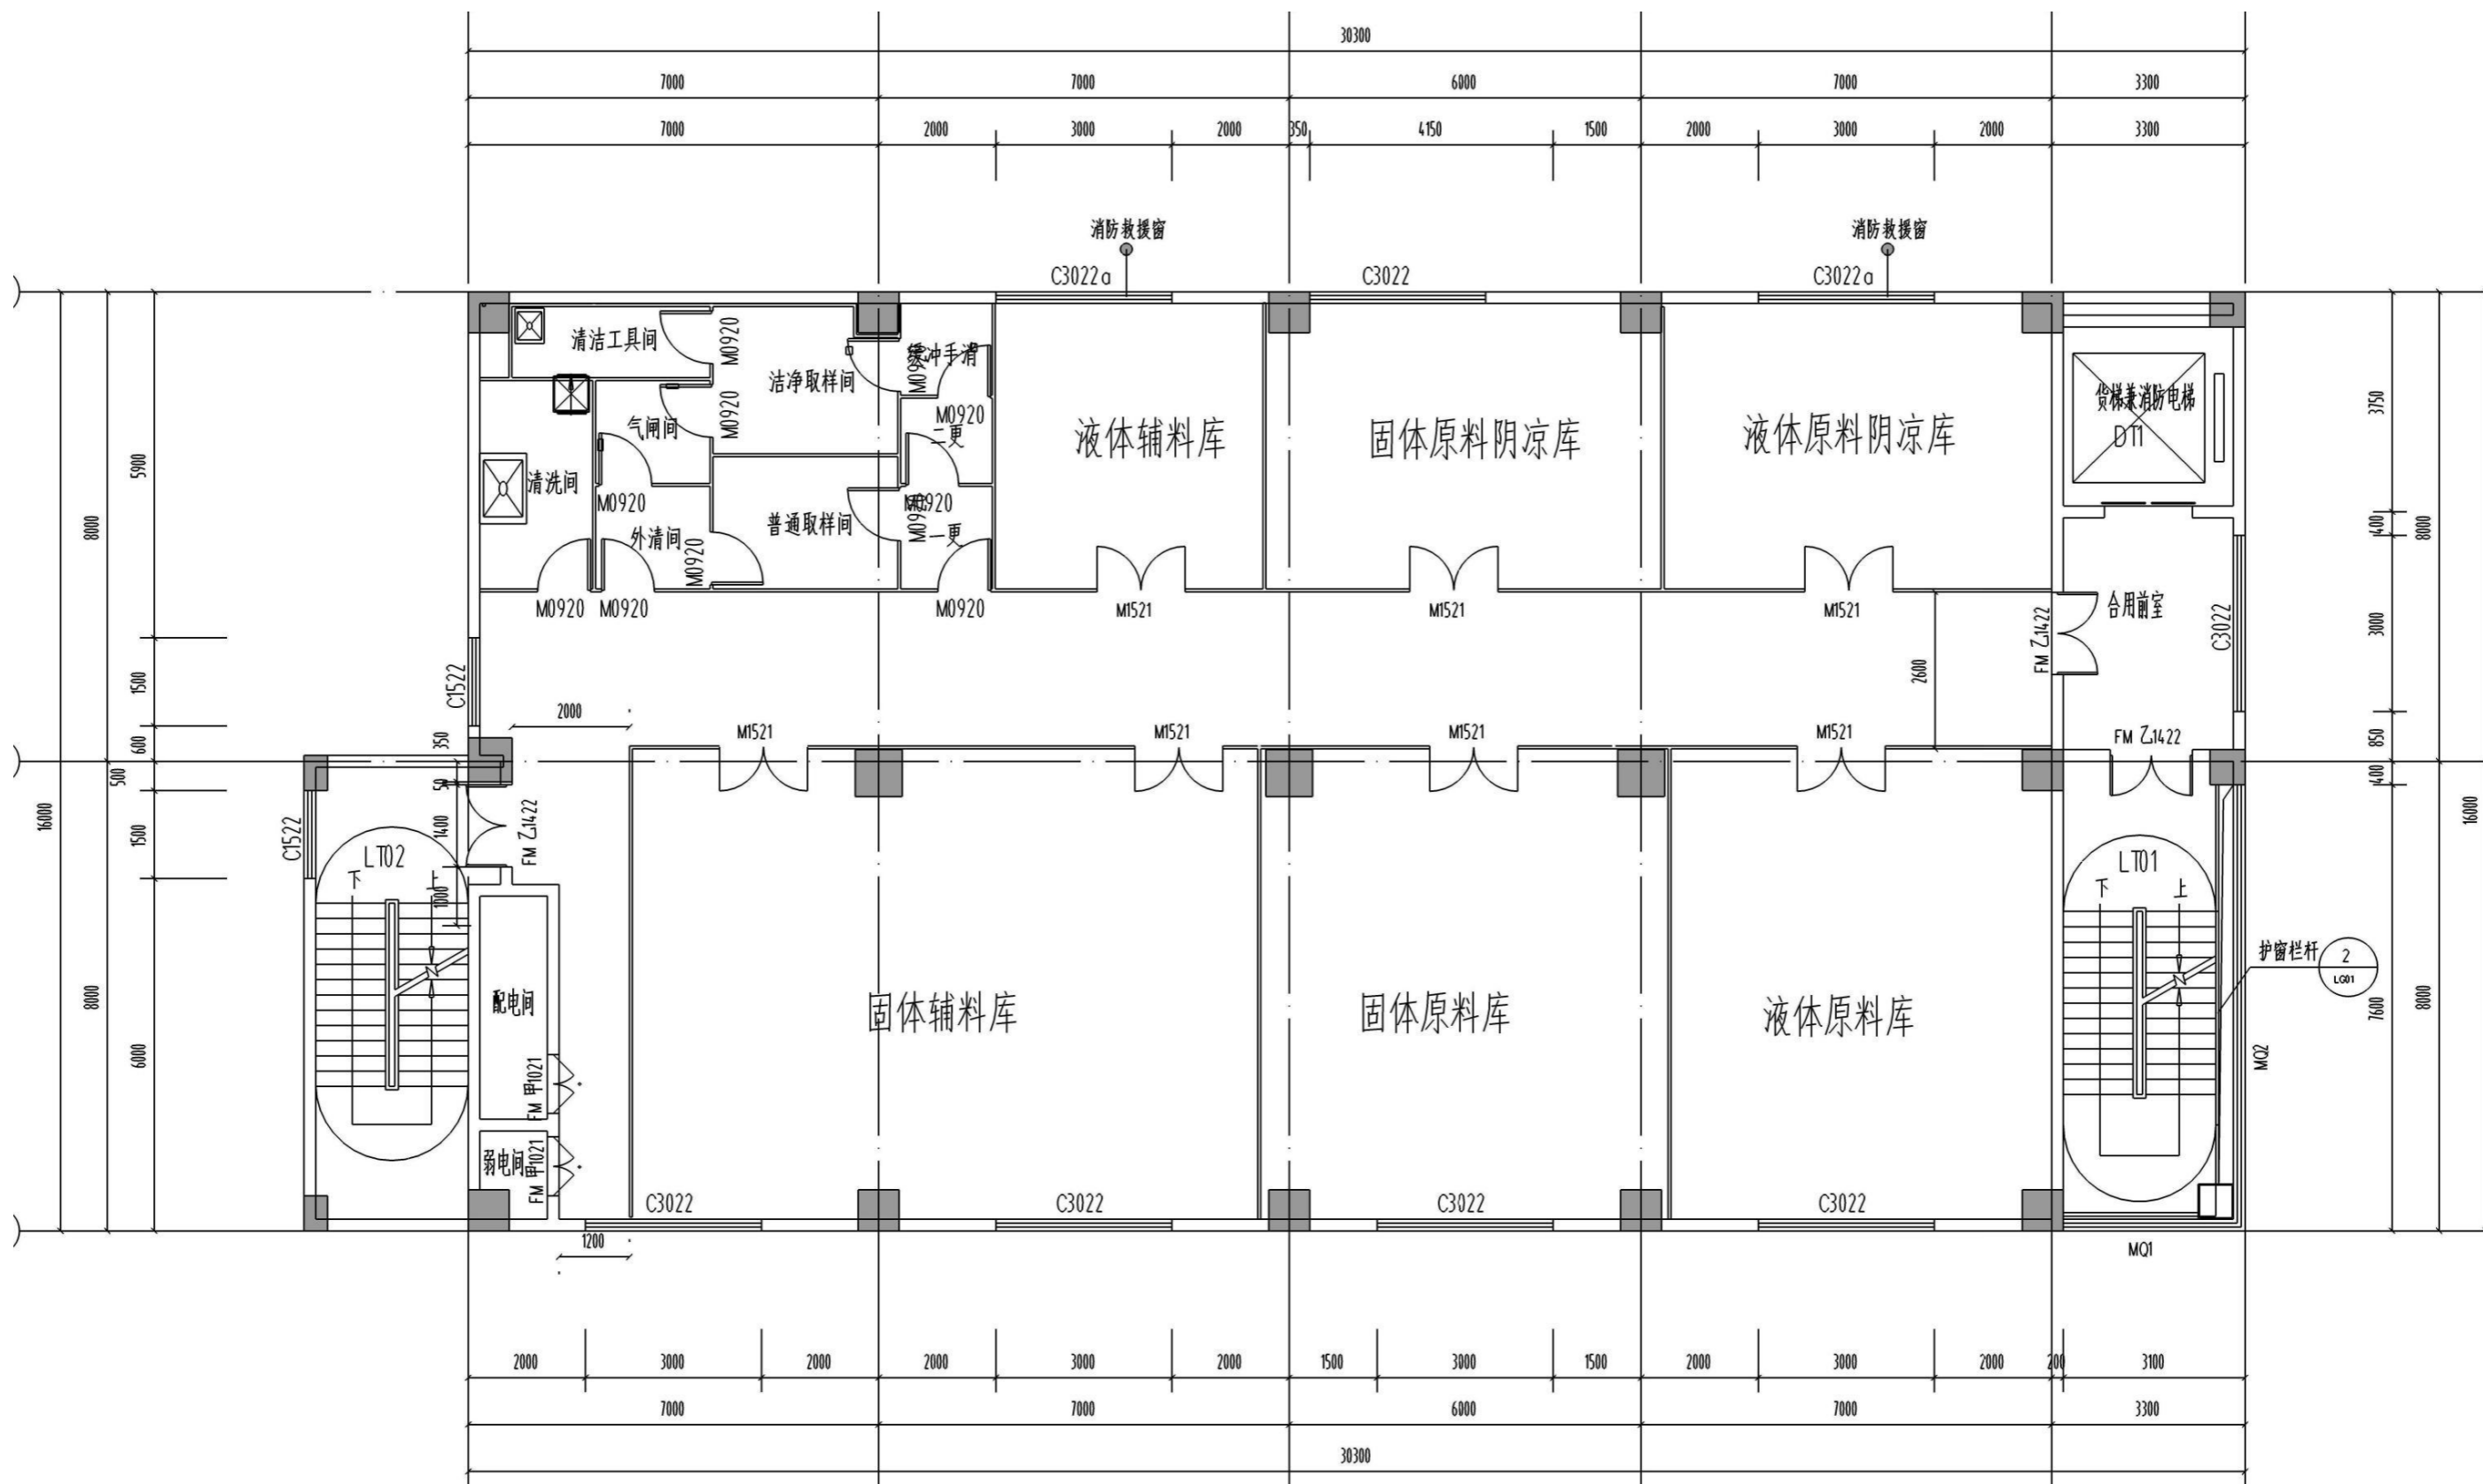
四层（原料仓库、取样间）平面布置图（比例尺 1:100）
